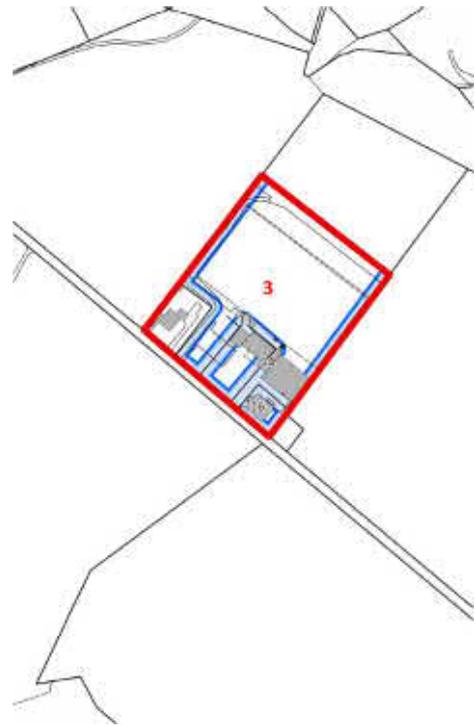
Gebäudelängen Schulhaus Ohmstal
